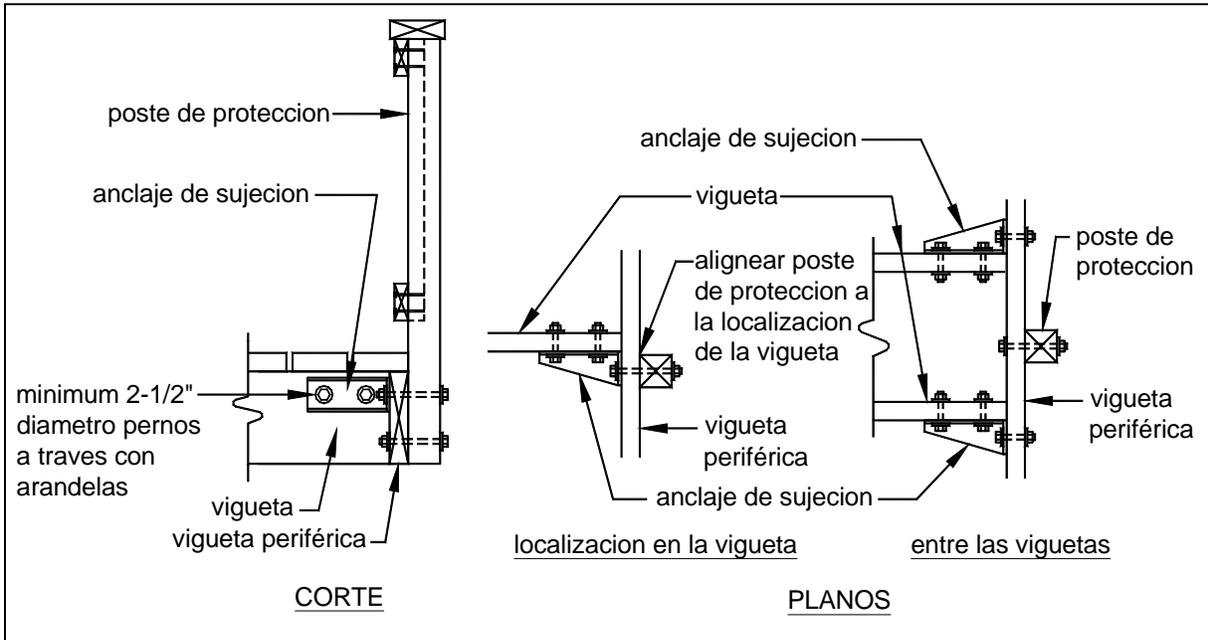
DETALLE DE UNIÓN DEL PILAR DE LA BARANDA A LA VIGUETA PERIFÉRICA, OPCIÓN 2
